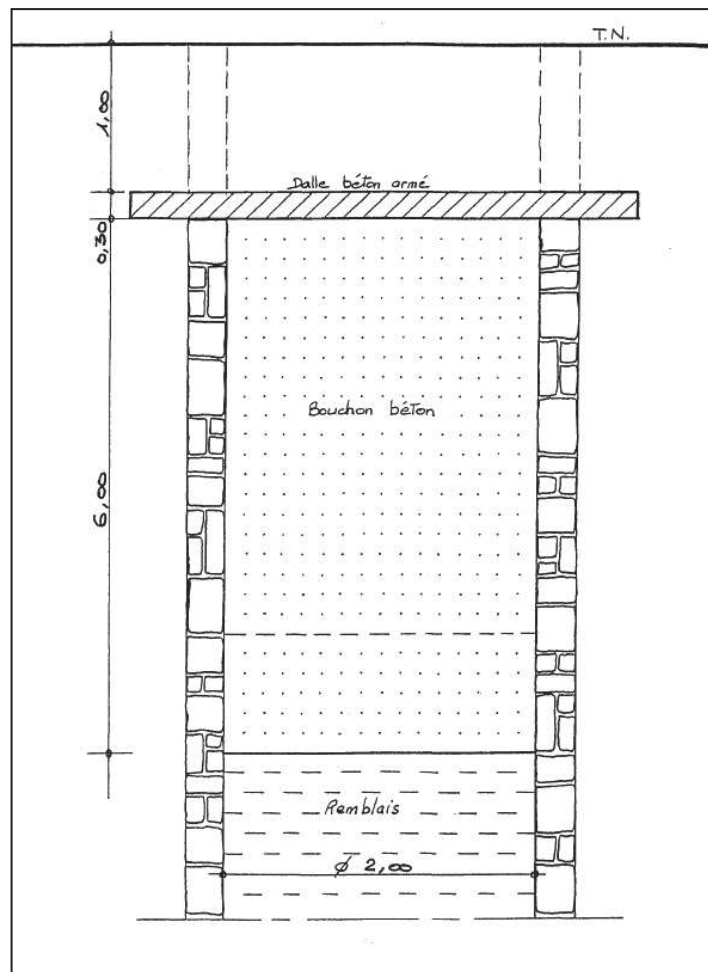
Schéma de mise en place du bouchon béton au puits de la Pompe – Aérage 1
